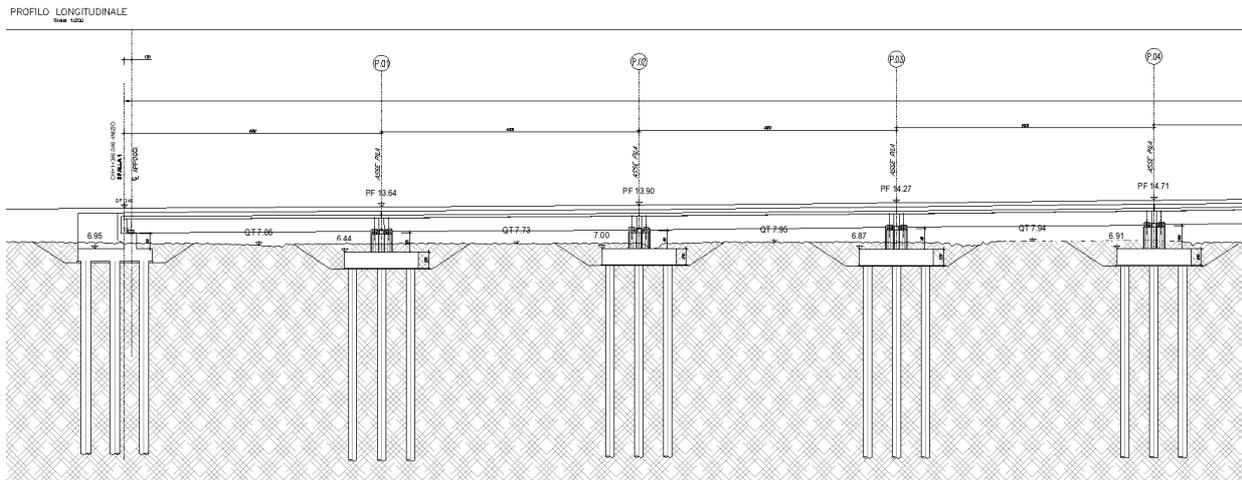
Prospetto - Ponte a struttura mista acciaio calcestruzzo a doppio binario
